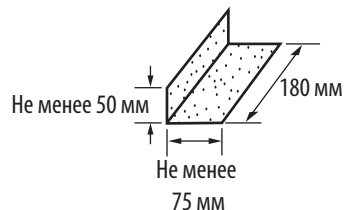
Металлическая гидроизоляция вокруг дымохода.
